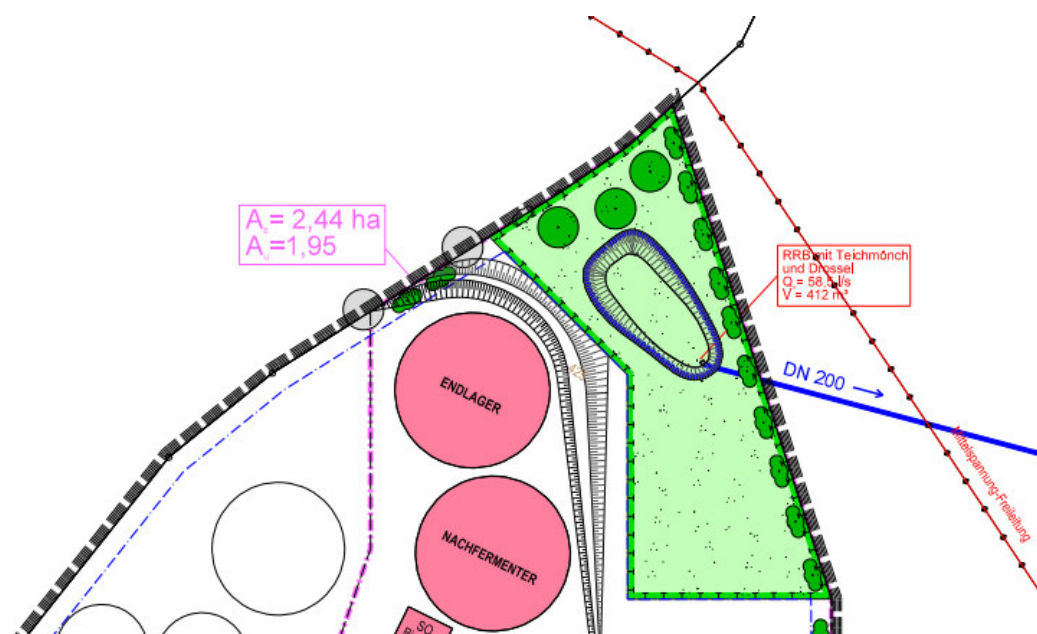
Ausschnitt Lageplan Flächen, IB Ferstl
